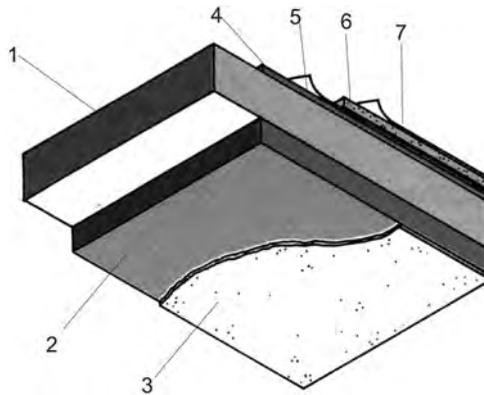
Теплоизоляция подвальных перекрытий: 1 — плита перекрытия; 2 — утеплитель; 3 — штукатурка; 4 — стяжка; 5 — гидроизоляция; 6 — утеплитель; 7 — рулонное напольное покрытие
